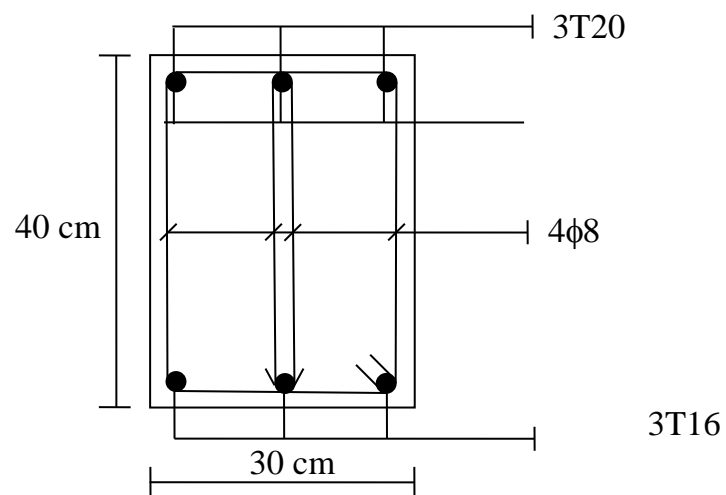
Schéma de ferrailage de la poutre Secondaire (Travée)
